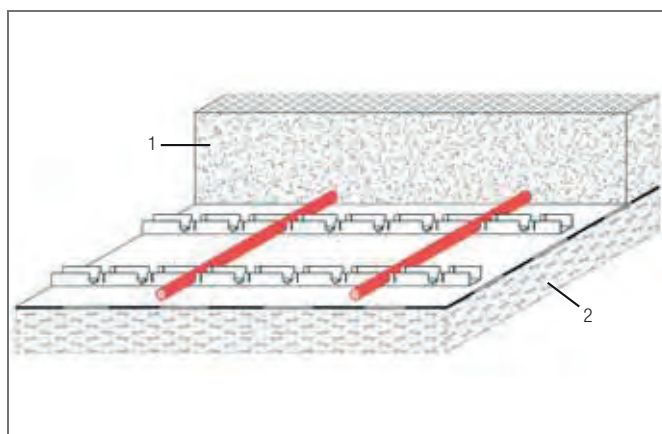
Płyta posadzkowa zbrojona siatkami stalowymi - konstrukcja specjalna z rurami grzewczymi zamontowanymi pośrodku płyty
